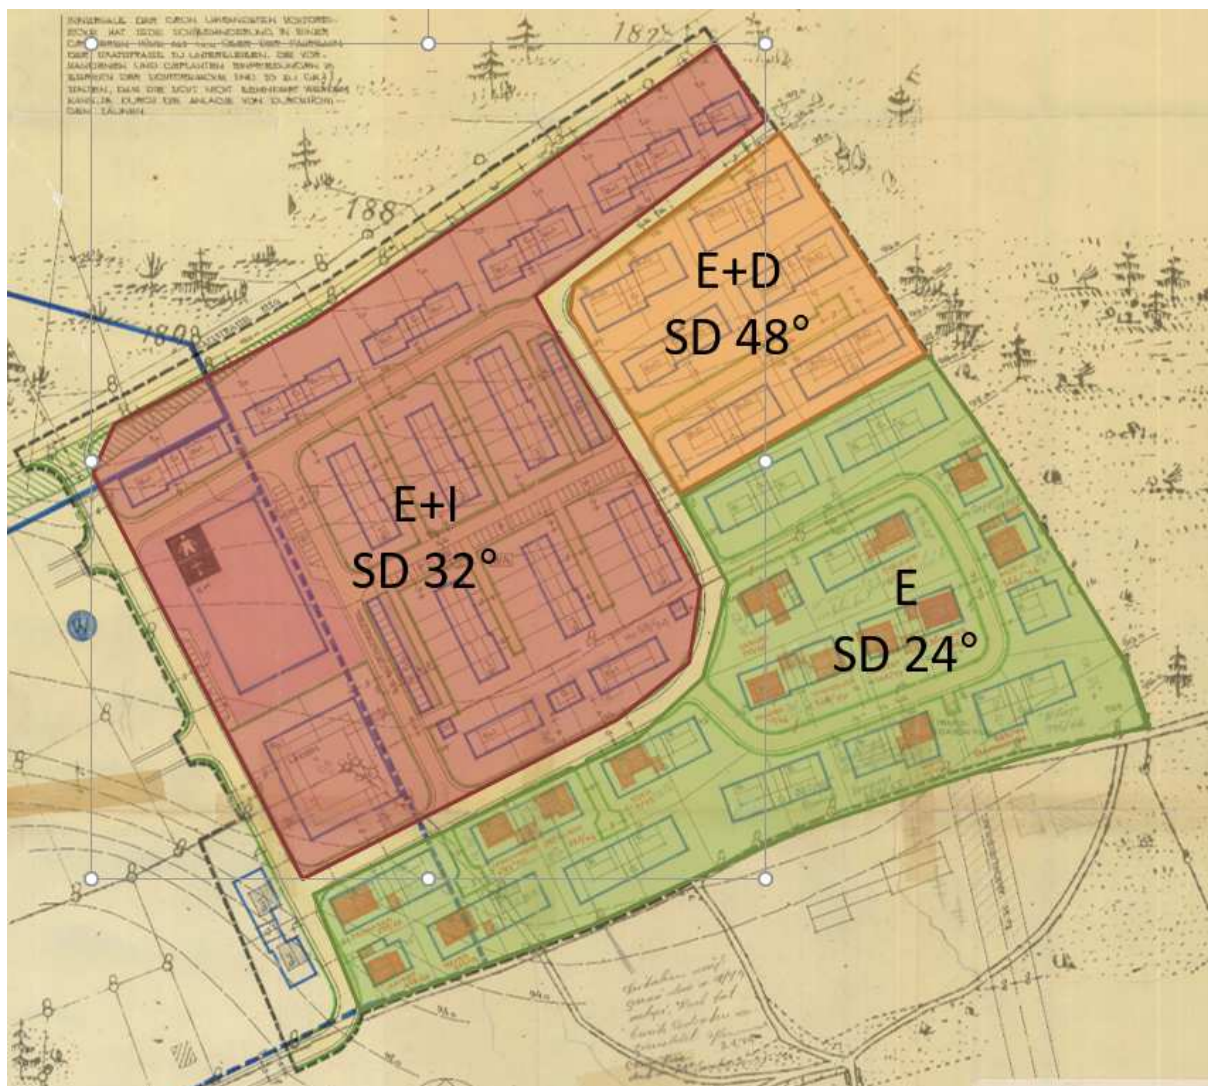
Zulässige Gebäudeformen gemäß ursprünglichem Bebauungsplan
